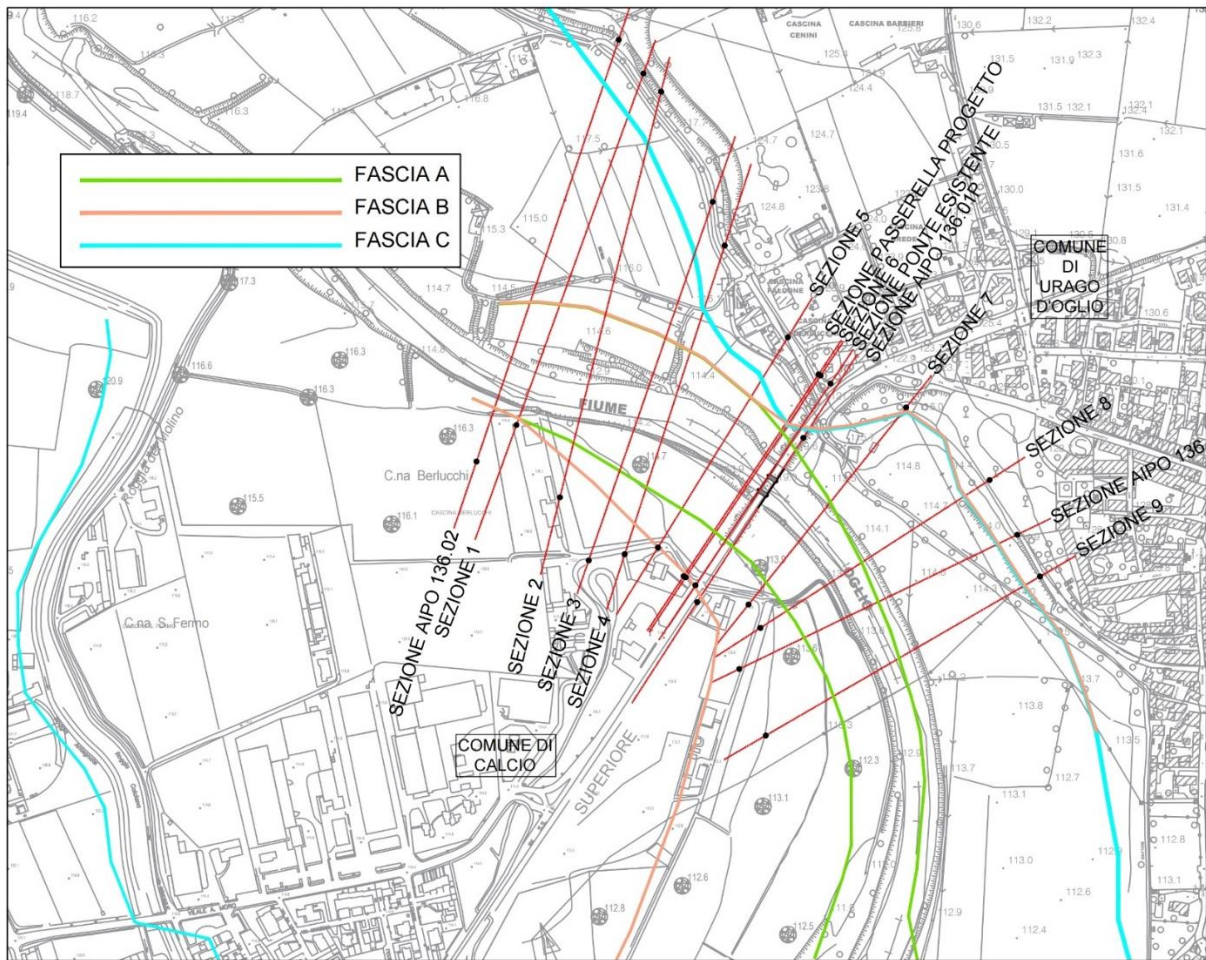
Planimetria con indicazione delle sezioni utilizzate per la modellazione
